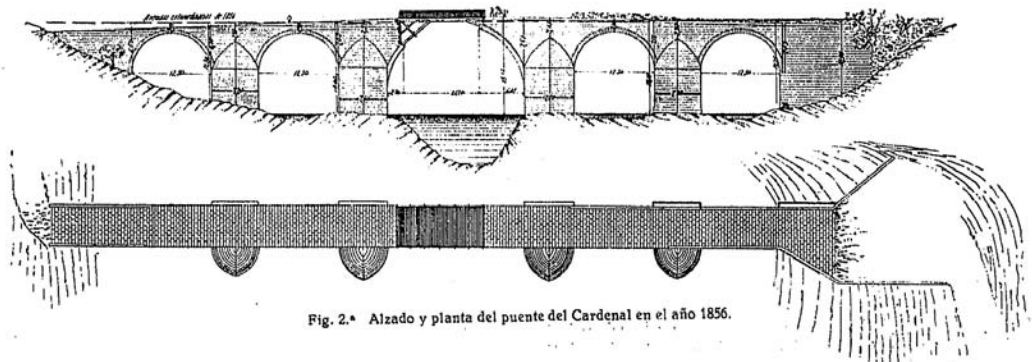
Alzado y planta del puente del Cardenal en el año 1856.
